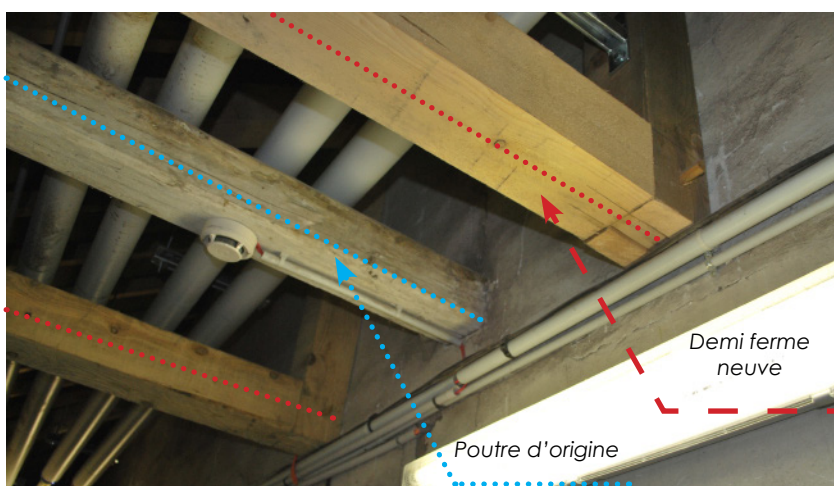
Juxtaposition d'une poutre et de deux demi ferme, aile sud
